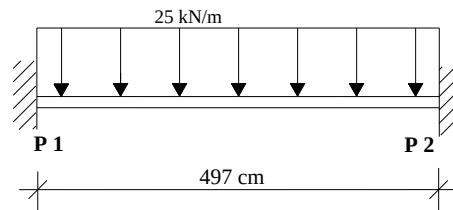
Esquema estático e carregamento no vão da viga adjacente ao pilar P1.
